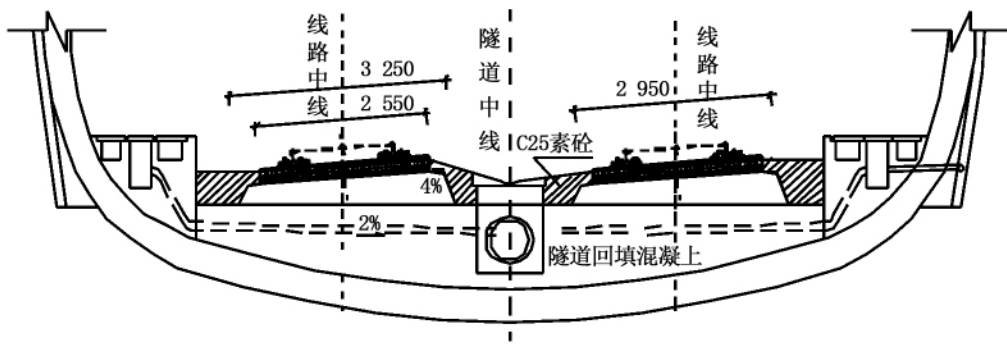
曲线隧道地段 II 型板式轨道断面图(单位: mm)
